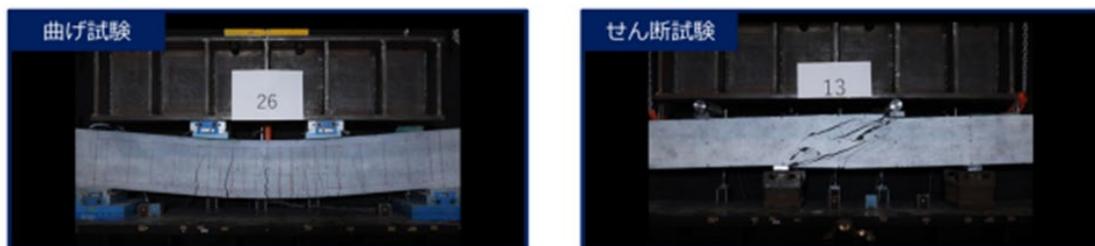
EeTAFCON 製鉄筋コンクリート梁の構造実験<sup>6)</sup>
